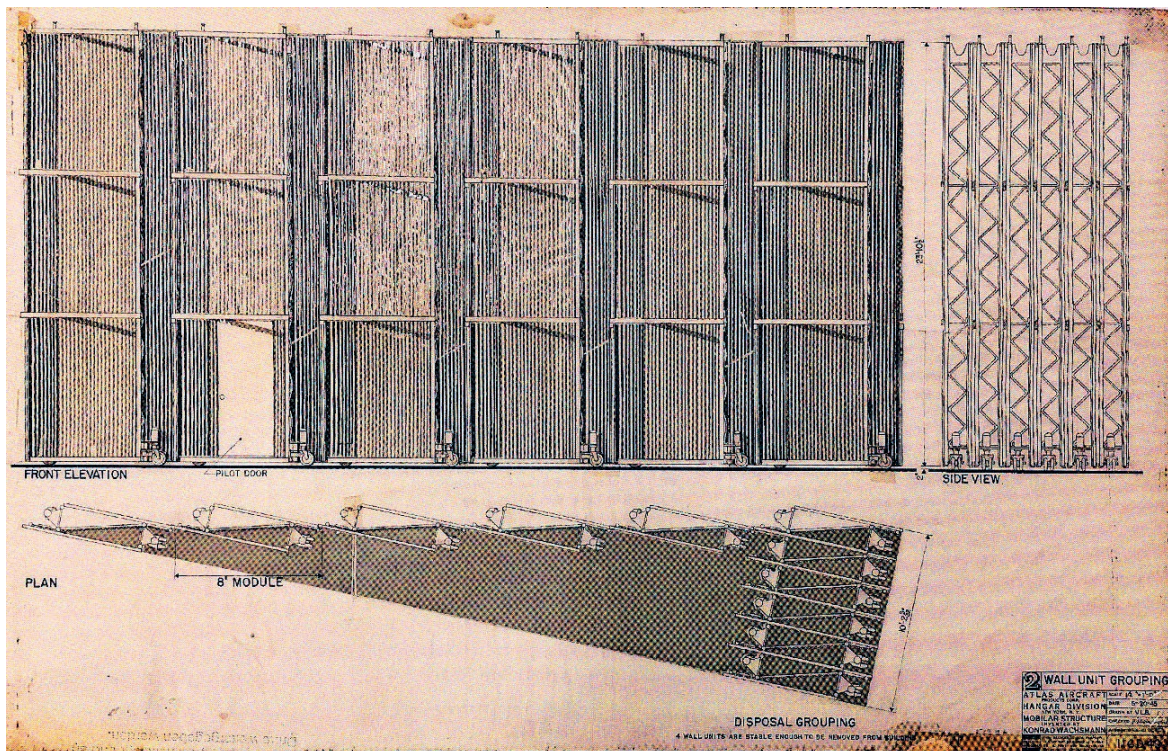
Konrad Wachsmann. *Mobilar Structure*. Wall Unit Grouping. El cerramiento móvil. 1945.
